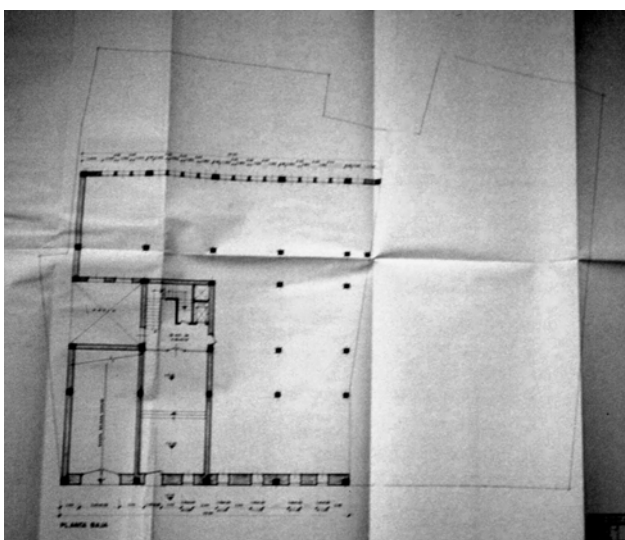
Rectorado y Secretaria General: planta baja, por Mancho Alario, 1974.
